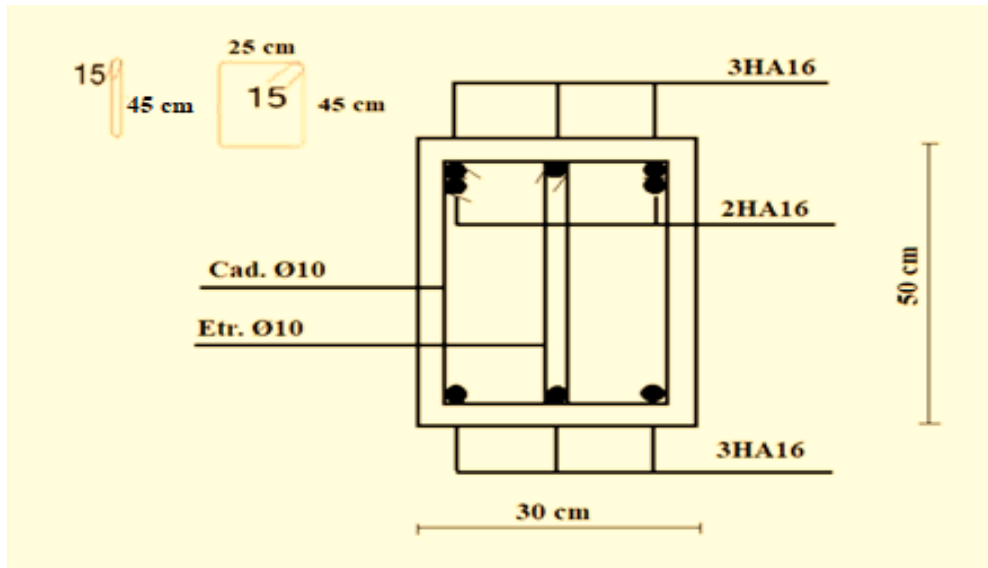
Ferrailage des poutres principales au niveau d'appuis.
